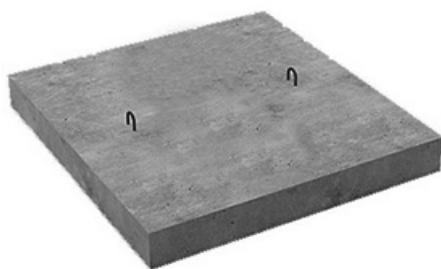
Железобетонная опорная плита марки ФП6.5-1
